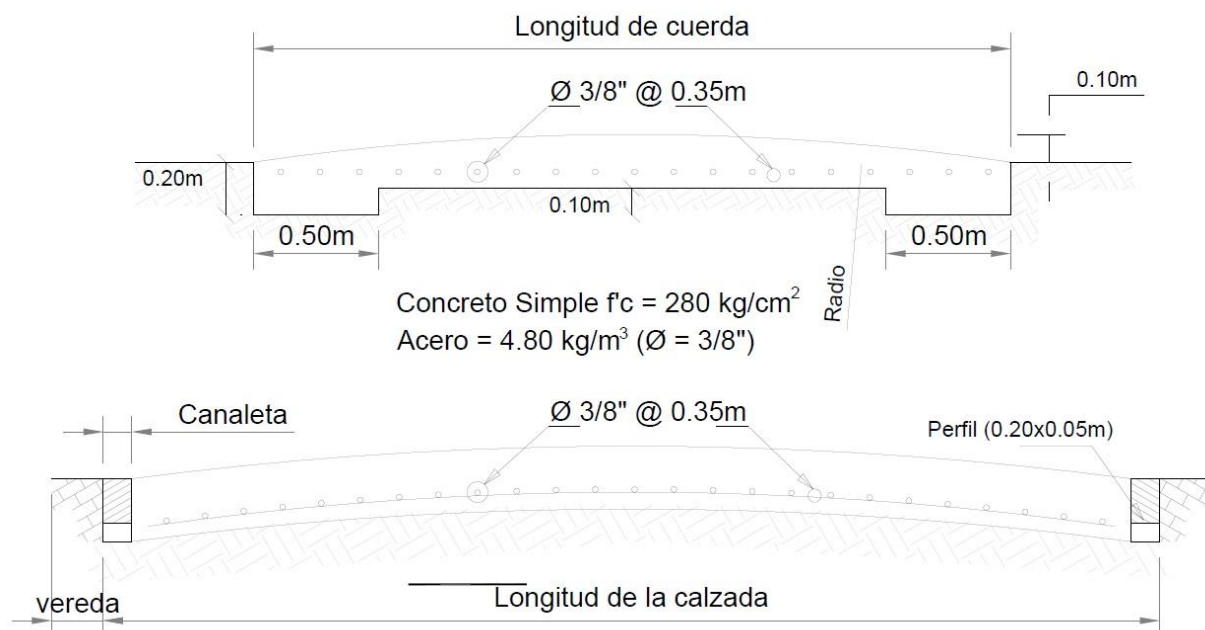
Detalle del Refuerzo para Resalto de Concreto Portland
